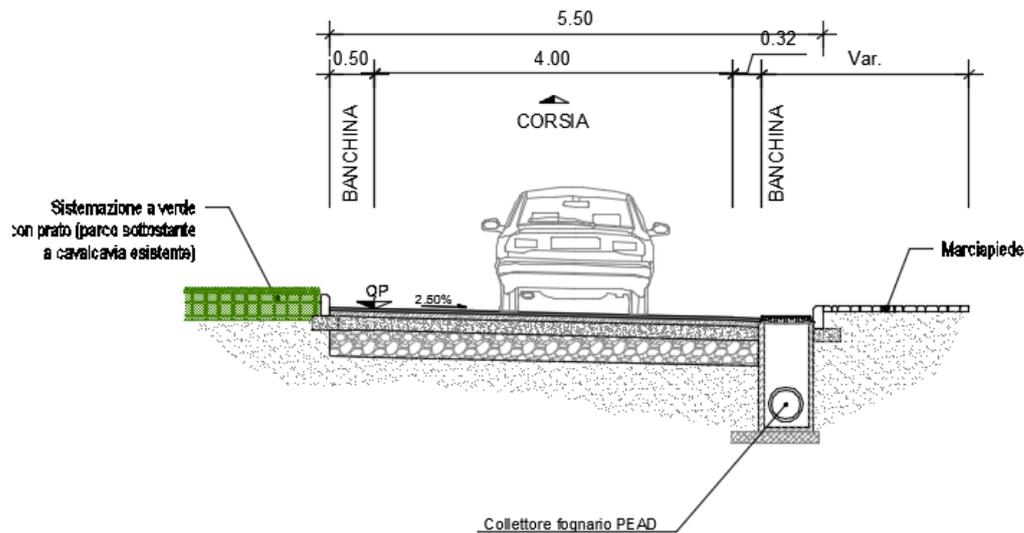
Sezione rampa d'accesso nuova viabilità (affiancamento a nuova sistemazione a verde)
